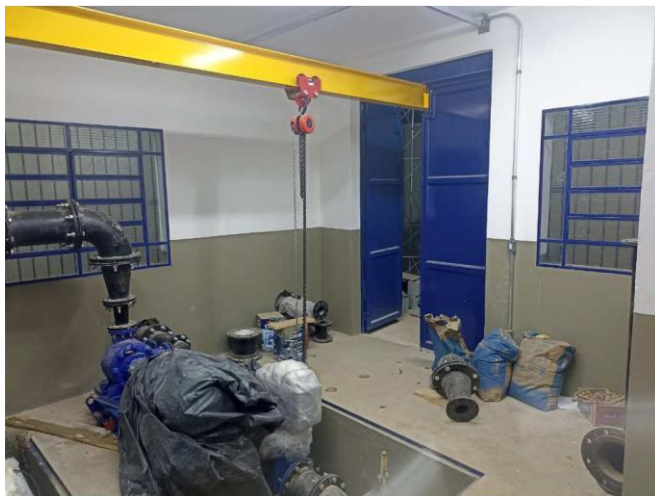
Vista interna da EEAT Mato Dentro com equipamentos instalados (Fonte: DAE, 2023).
